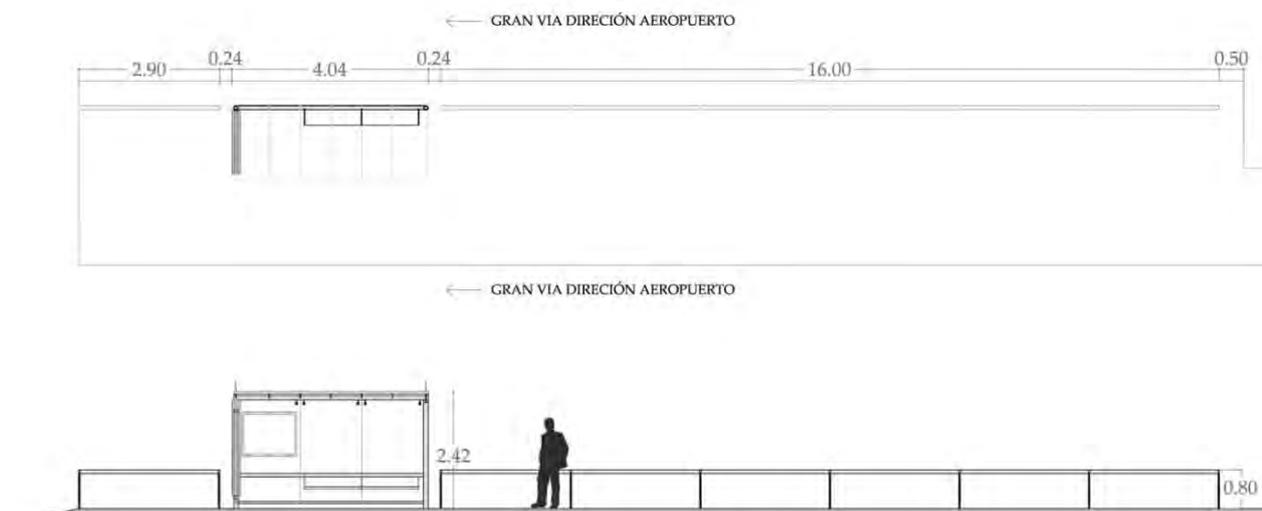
Planta y alzado parada 907 Gran Vía Moianés. Dibujos de la autora.
